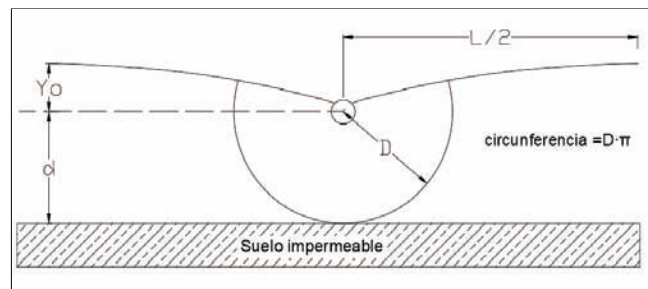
Dren circular por encima de capa impermeable. (Irrigation and Drainage Engineering)
